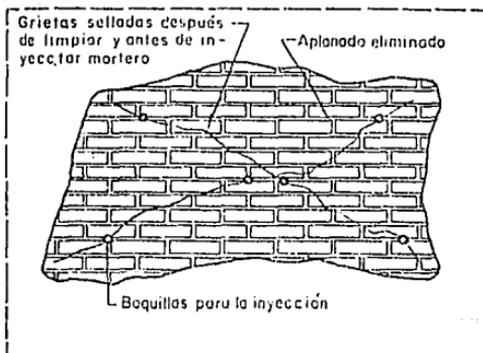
Inyección de cuarteaduras en muros de mampostería.
